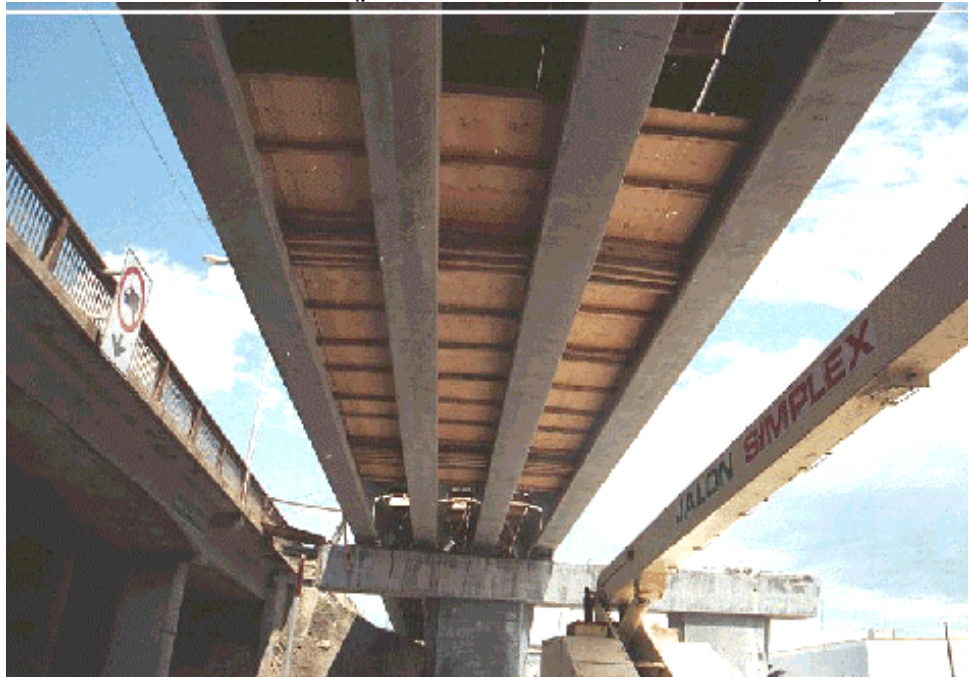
Plancher de sécurité et fond du coffrage des entretoises intermédiaires sur la travée 3 (photo 280.2.23, prise après l'accident)
